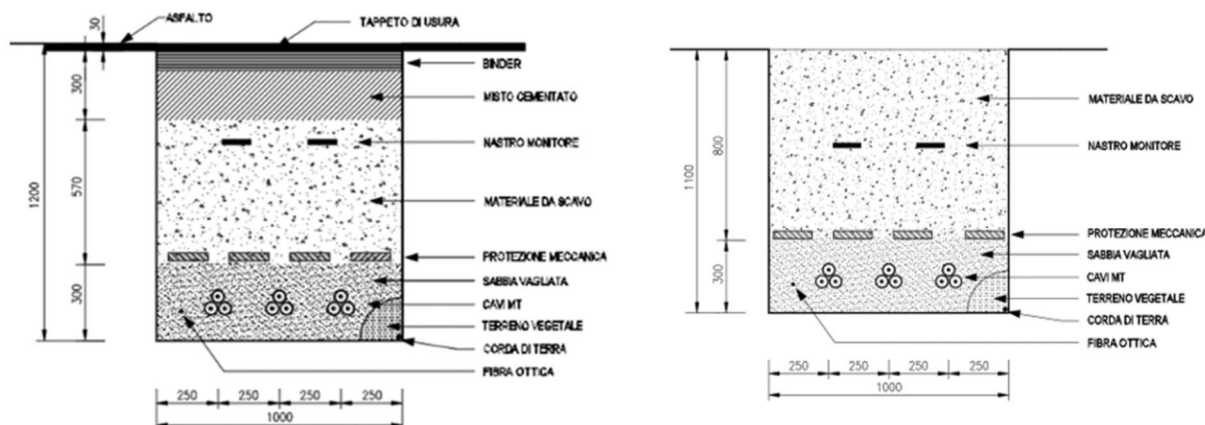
Sezioni tipo cavidotto – su Strada e su Terreno
